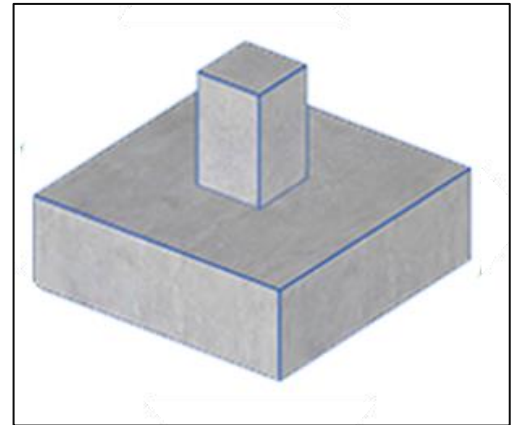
semelle isolée Source : <https://alt-ancre.fr/fondations-superficielles/>
